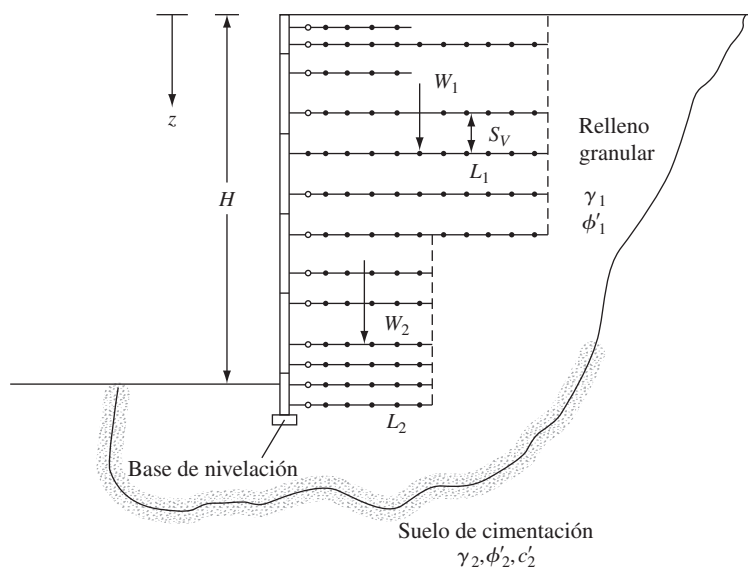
Diseño de un muro de contención reforzado con geomalla
